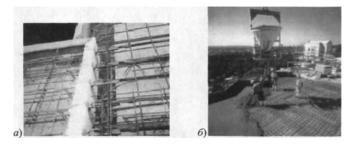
Сборно-монолитные перекрытия с несъемной опалубкой, а –сопряжение плиты перекрытия с консольной плитой балкона, б – укладка монолитного бетона в плиту перекрытия по несъемной опалубке
